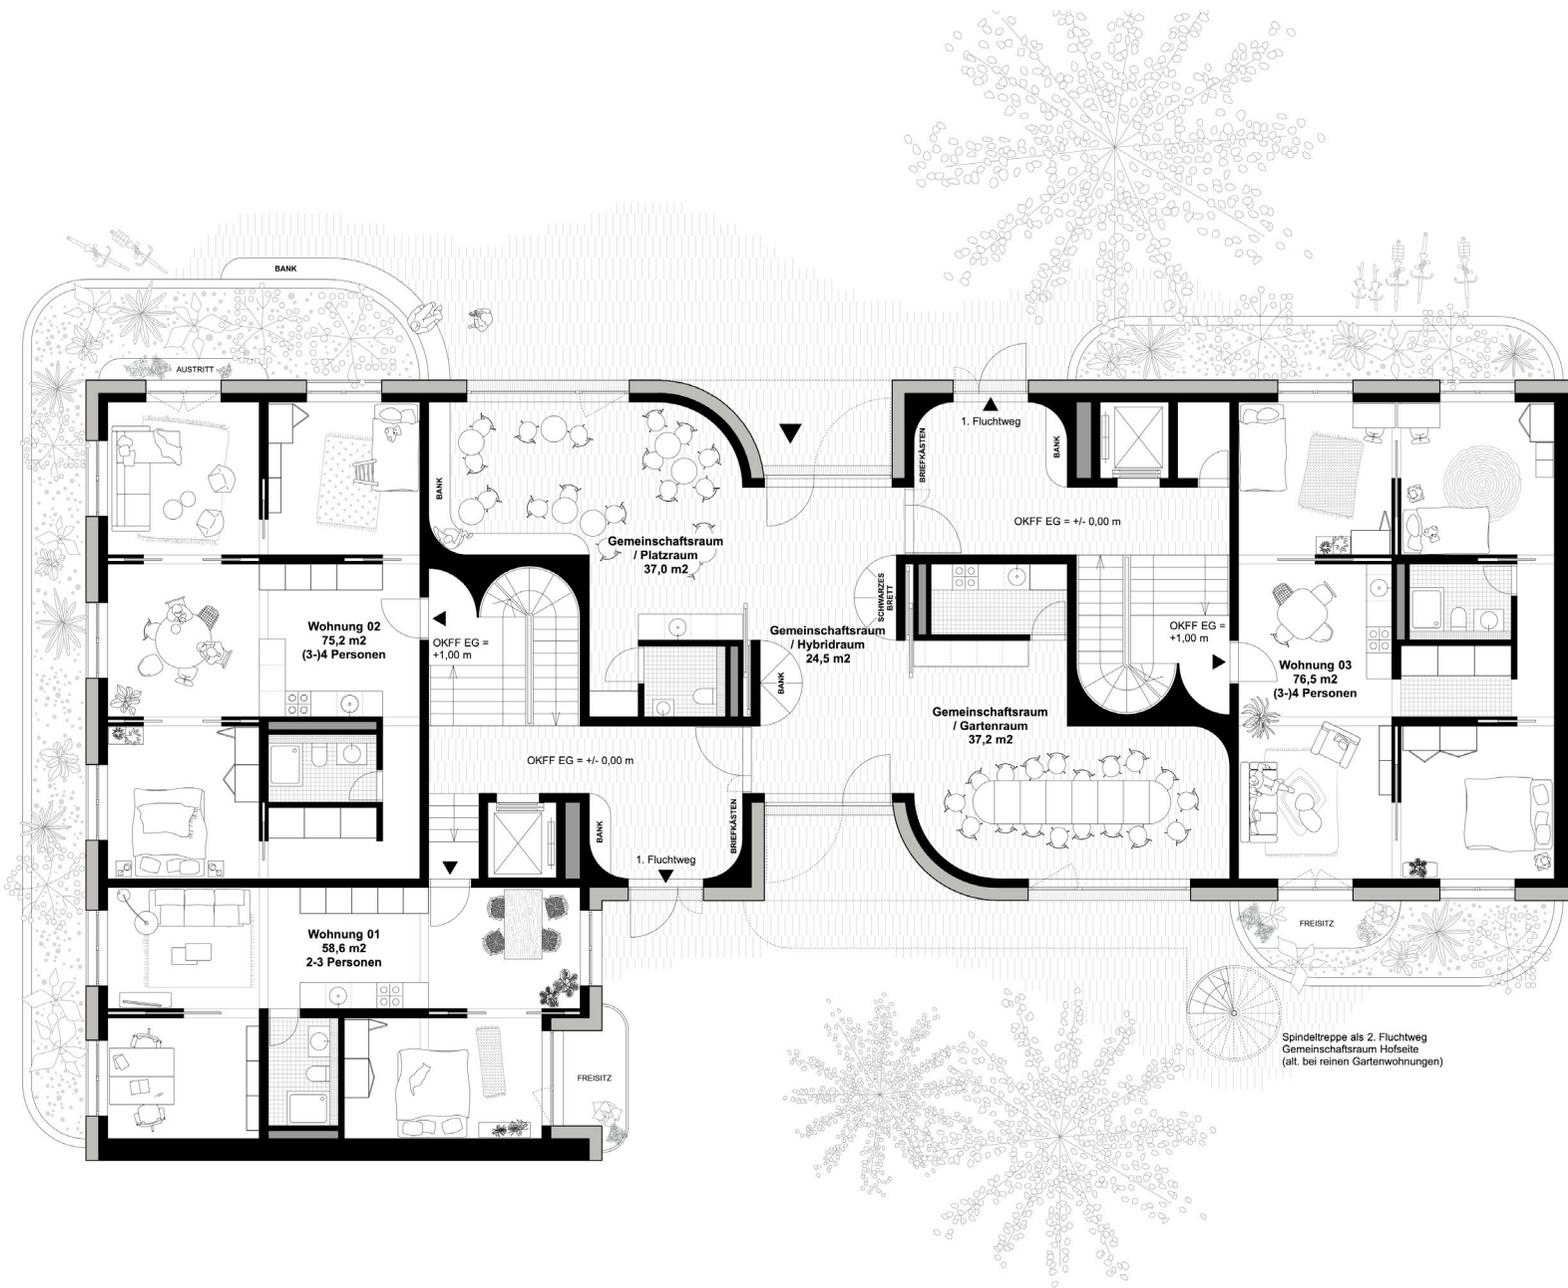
Erdgeschoss | M 1:175 | Kirsten Schemel Architekten BDA (Berlin)
